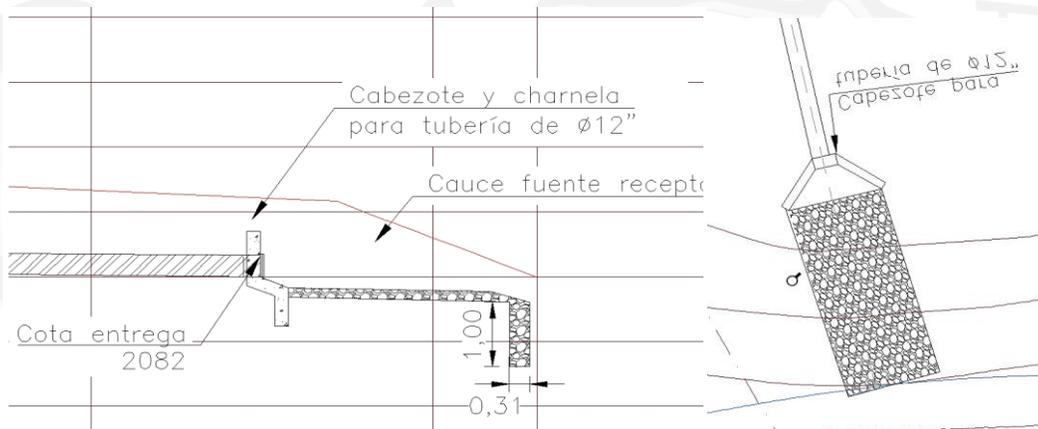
Tipo de la Obra:		Tubería de acero Km 0+243
